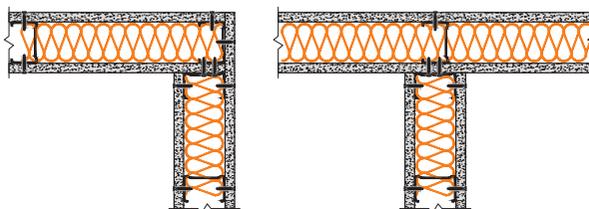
Tabique reticulado con estructuración en base a Acero Galvanizado.
